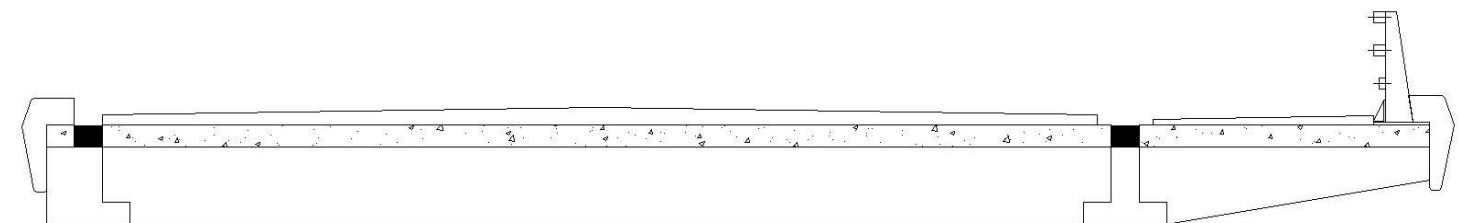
Sección transversal del tablero del puente doble arco atirantado de tablero inferior
